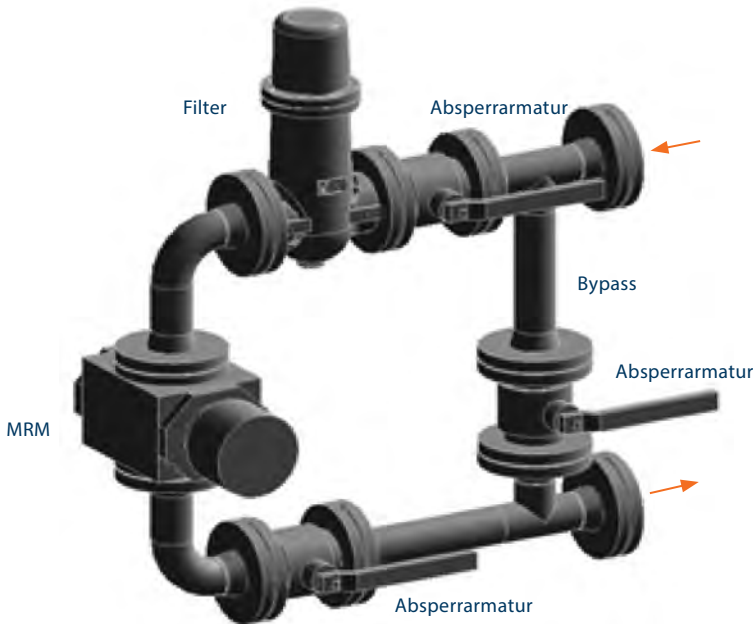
Typische vertikale Installation des MRM Drehkolbengaszählers
